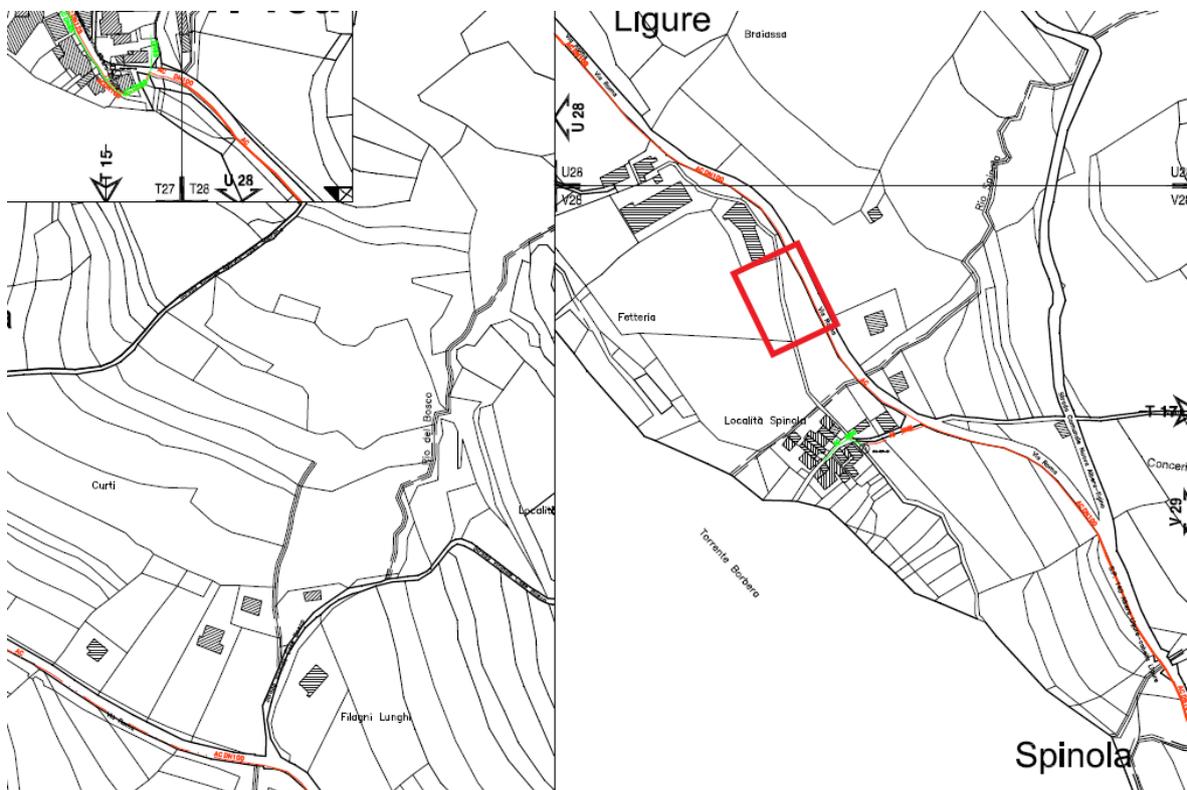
Estratto Planimetria di Rete (Tav.15b)
